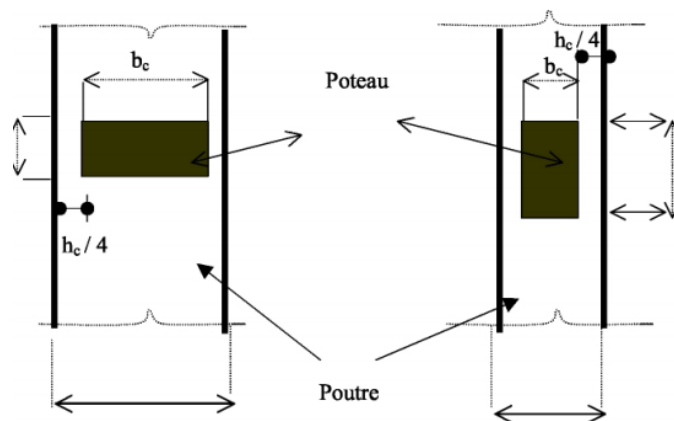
Position poteau poutre/ Excentricités des axes poteaux-poutres
